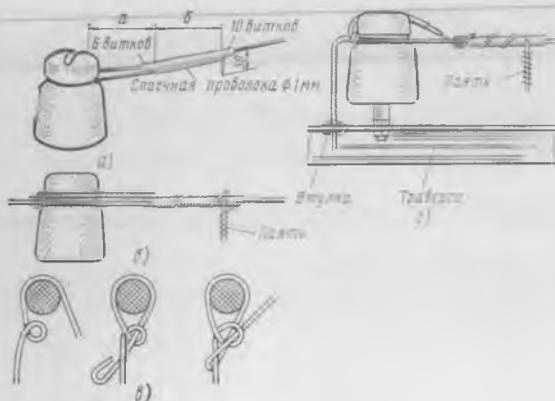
Соединение линейного провода с проводом ЛТВ-В: а) размеры оконечной заделки линейного провода; б) соединение линейного провода с проводом ЛТВ-В при установке изолятора на крюке; в) этапы обвязки провода ЛТВ-В вокруг шейки изолятора; г) соединение линейного провода с проводом ЛТВ-В при установке изолятора на траверсе.
